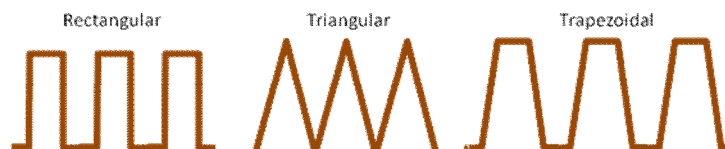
Vista en planta de los tipos de vertedero de laberinto
